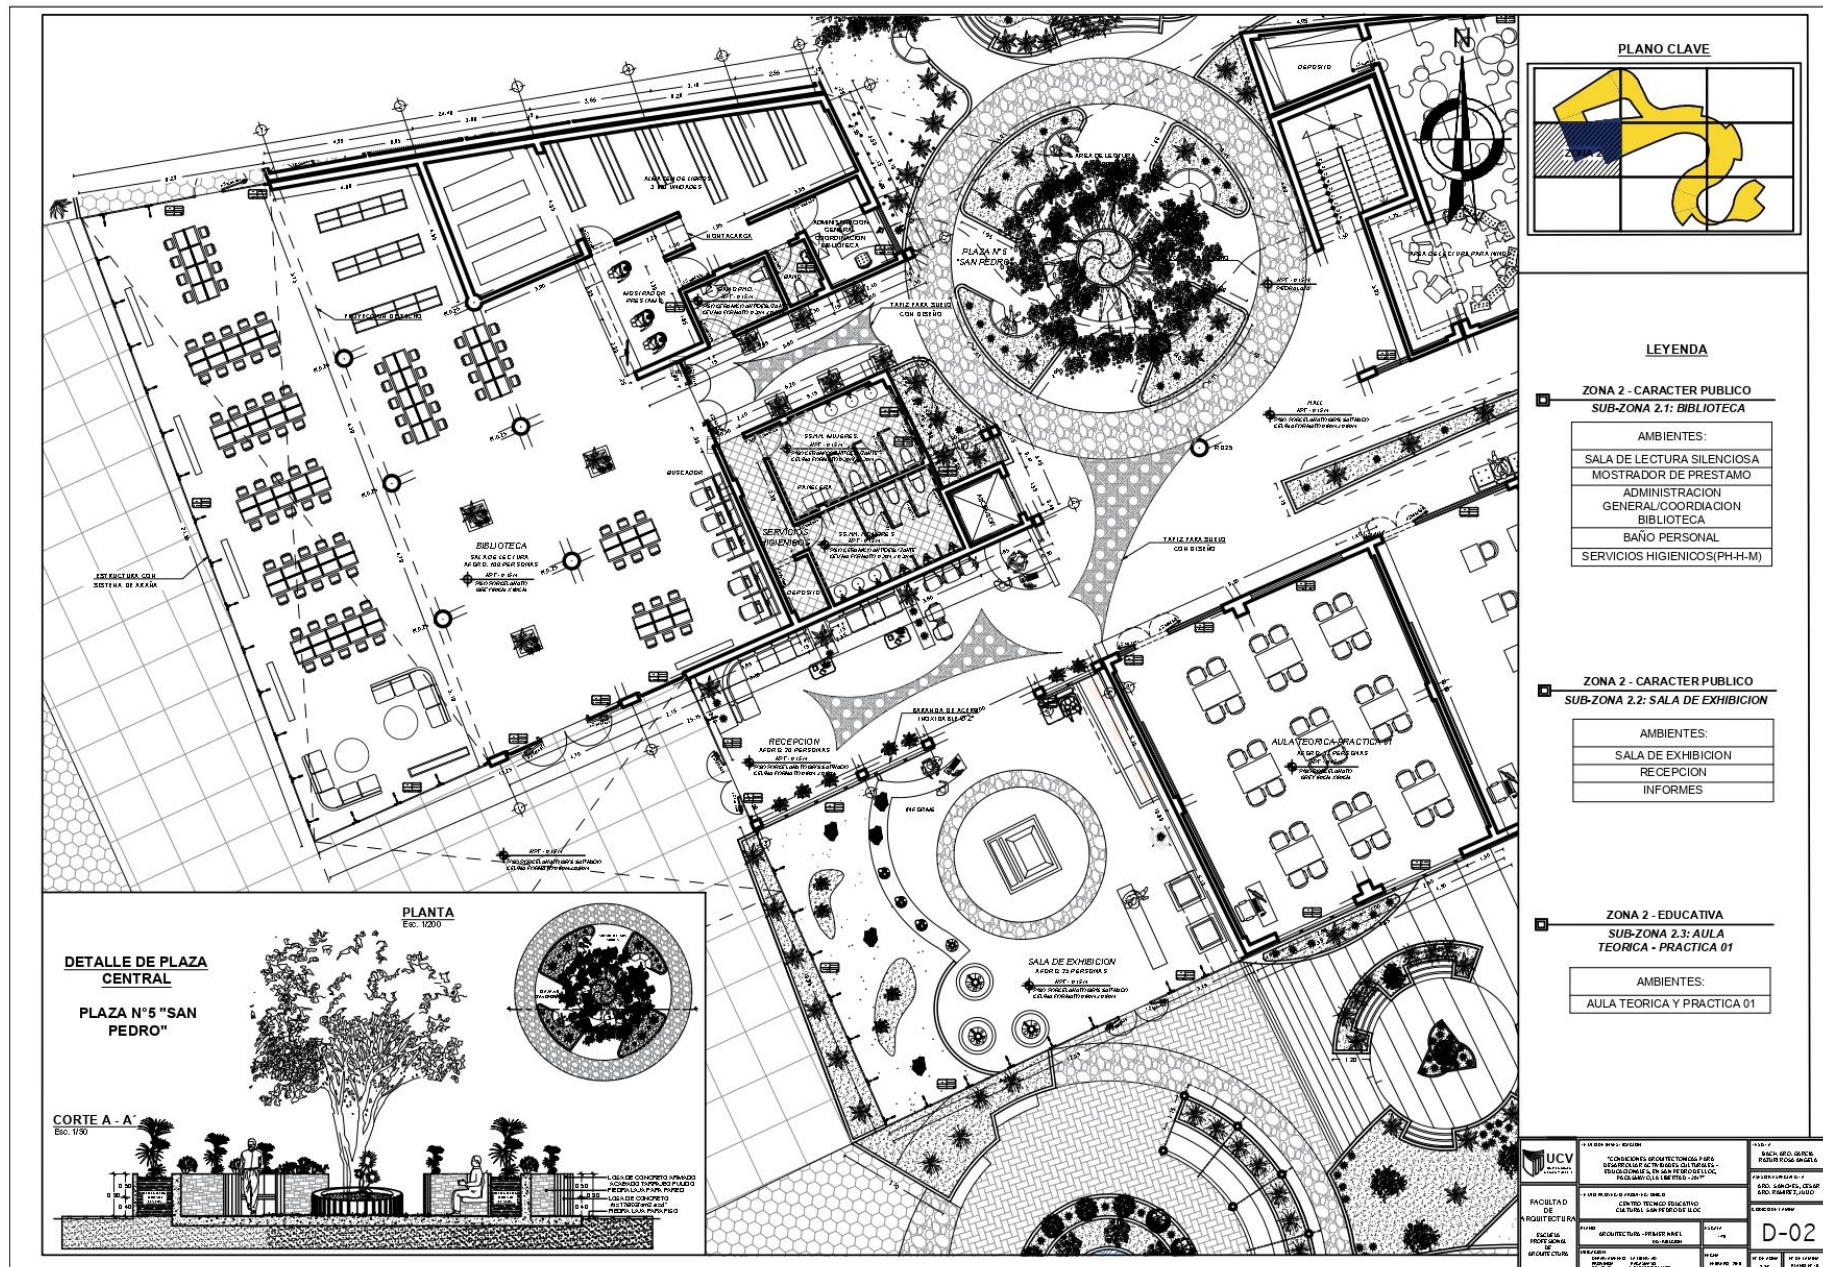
Plano de Desarrollo por Zonas - Plano N° 10 - Lamina N°: D - 02
